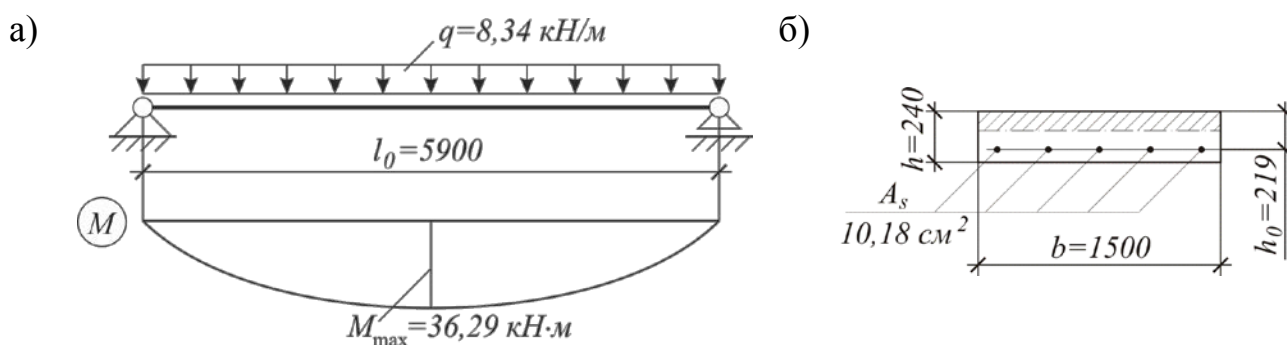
Расчетная схема (а) и расчетное поперечное сечение (б) плиты
